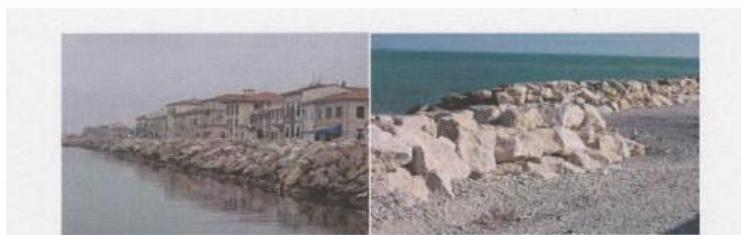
Muro verticale in calcestruzzo con protezione al piede con massi naturali (APAT, 2007).
